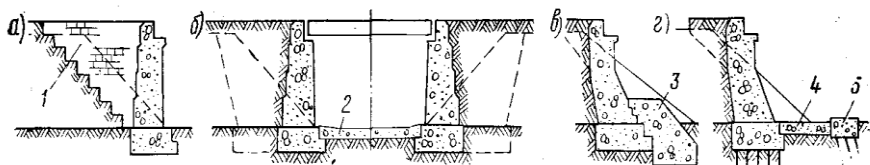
Схемы усиления устоев: а – замена грунта за устоем сухой кладкой; б – распорной перемычкой между фундаментами устоев (в местах малой длины); в – устройством контрфорса; г – железобетонной распоркой с упором; 1 – кладка; 2 – перемычка; 3 – контрфорс; 4 – распорка; 5 – упор
